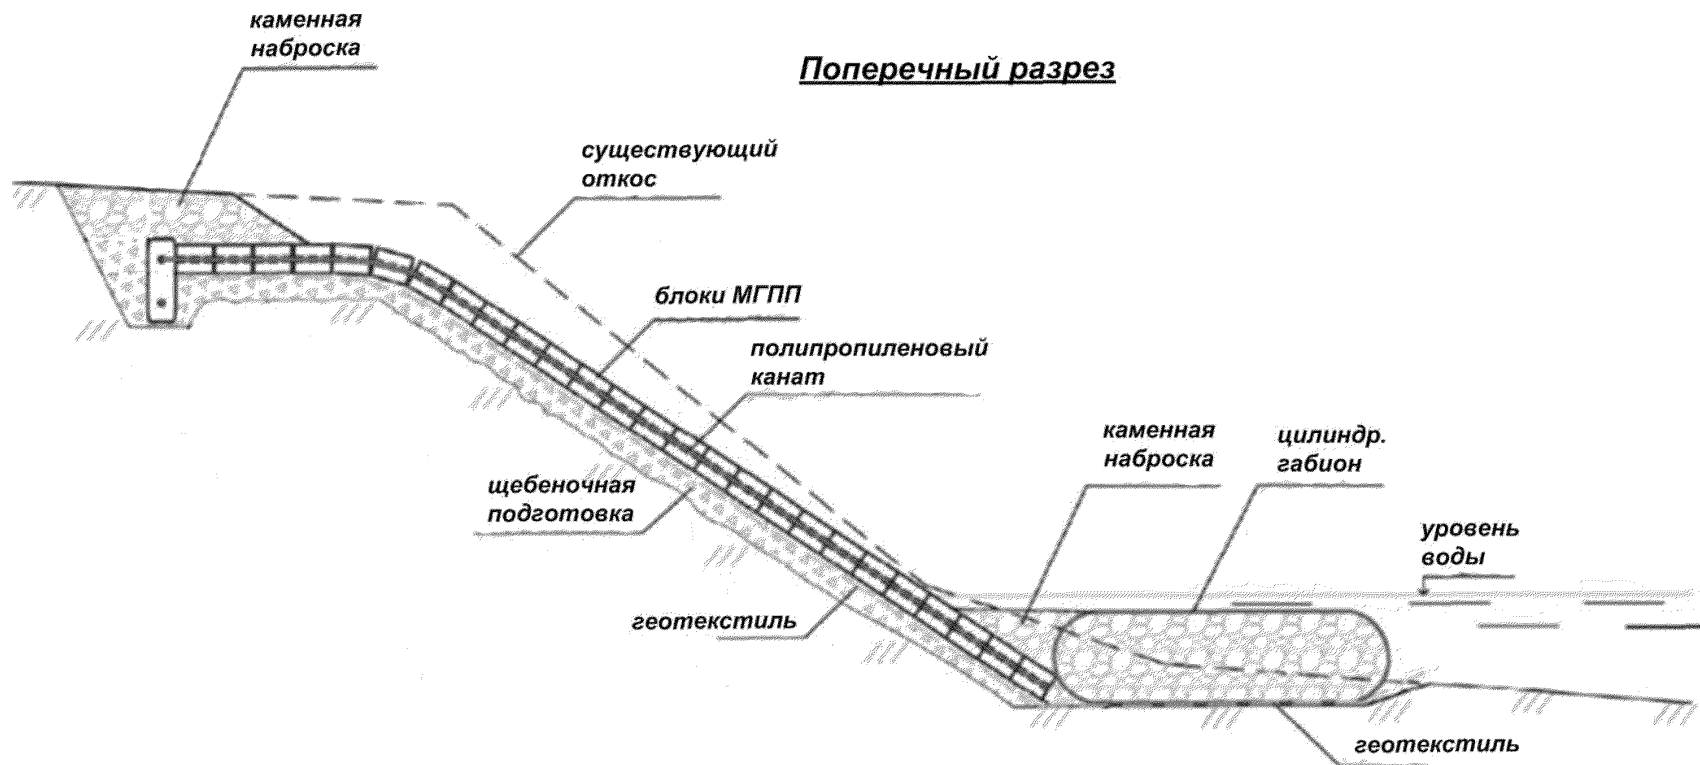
Вариант берегоукрепления. Поперечный разрез.
